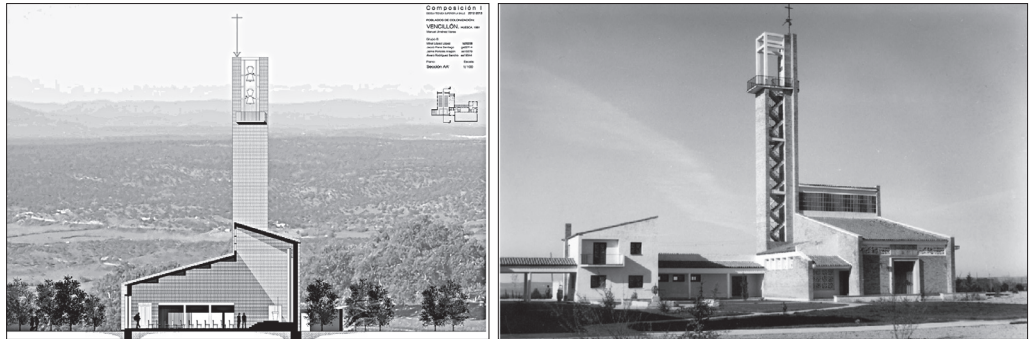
Fotomontaje sobre la sección longitudinal y vista exterior
